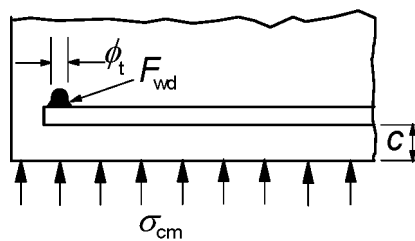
Barra transversal soldada como dispositivo de anclaje
